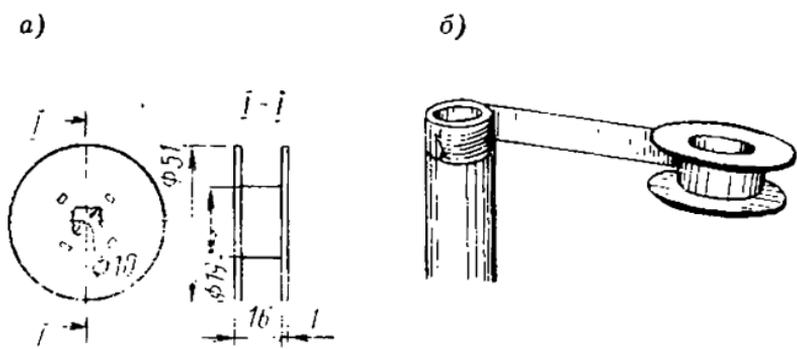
Приспособление для намотки ленты ФУМ на резьбу трубы
